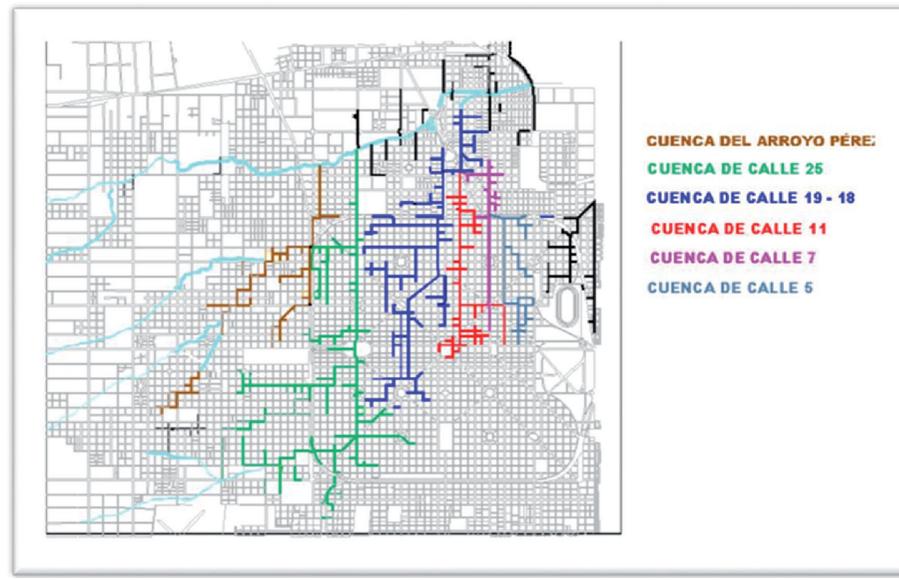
Imagen esquemática del sistema de pluviales de La Plata anterior a las obras
